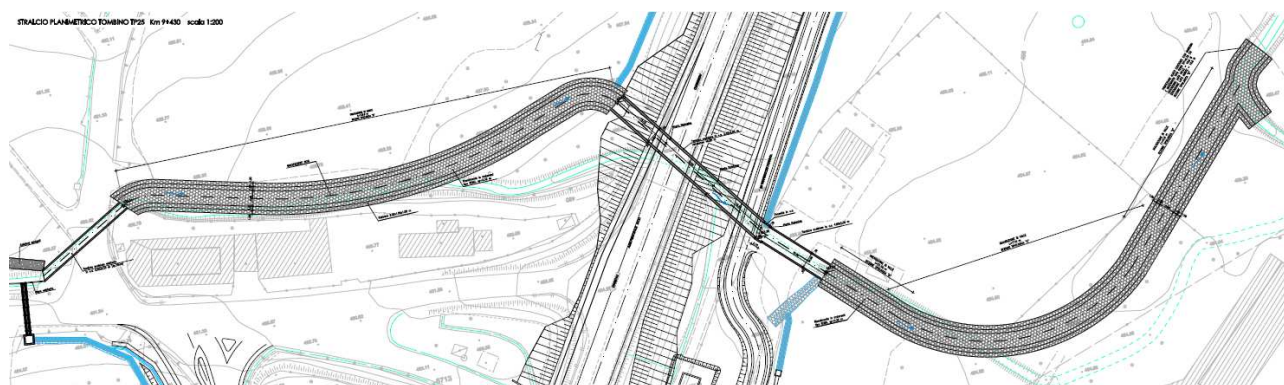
Stralcio planimetrico TP25 IN36-IN37
